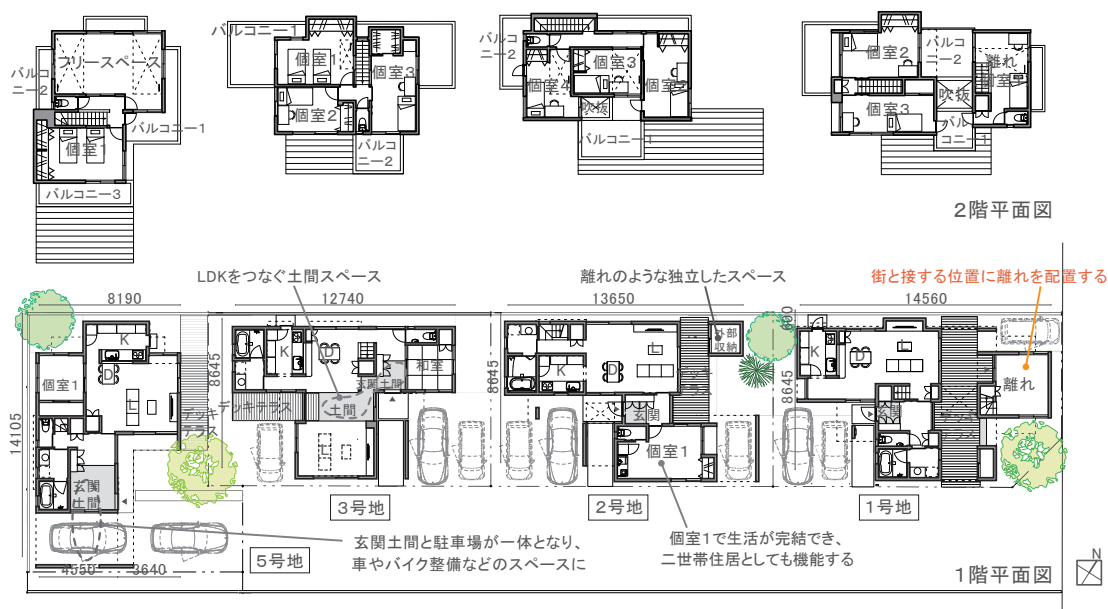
分譲住宅 C：全体平面図兼配置図 1/400
